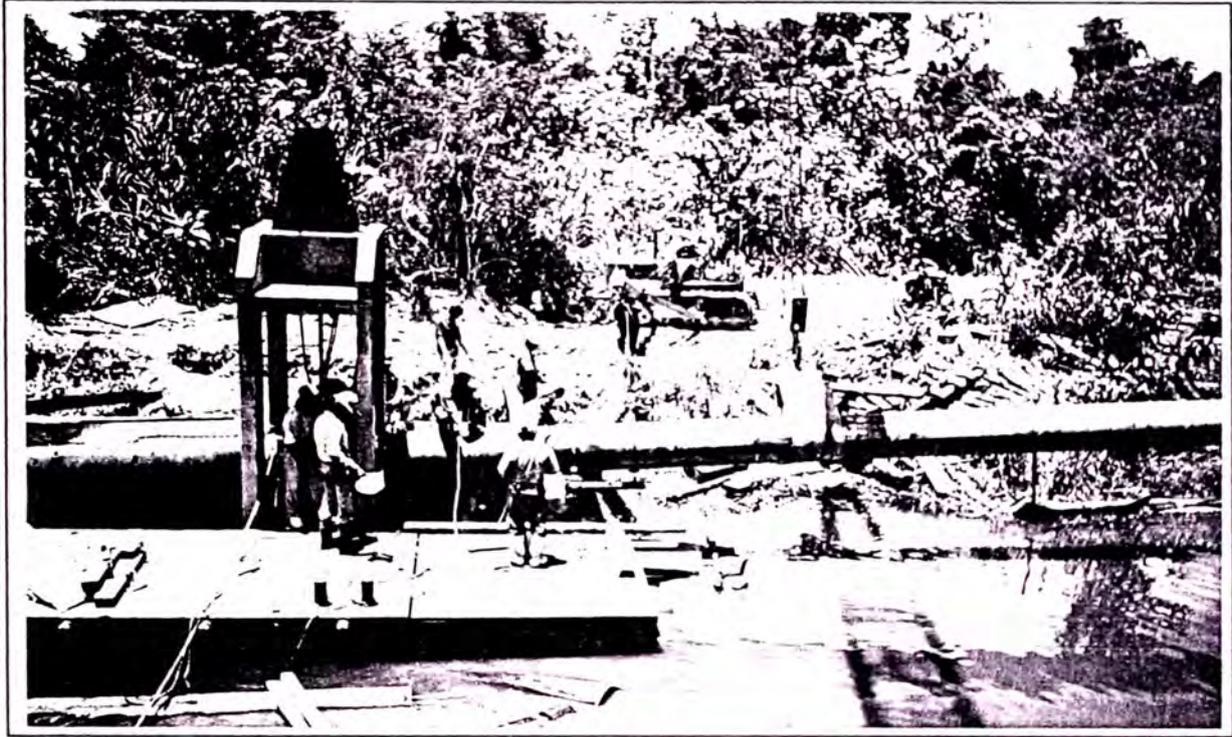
Alineamiento y soldadura de las tuberías en la margen derecha.
